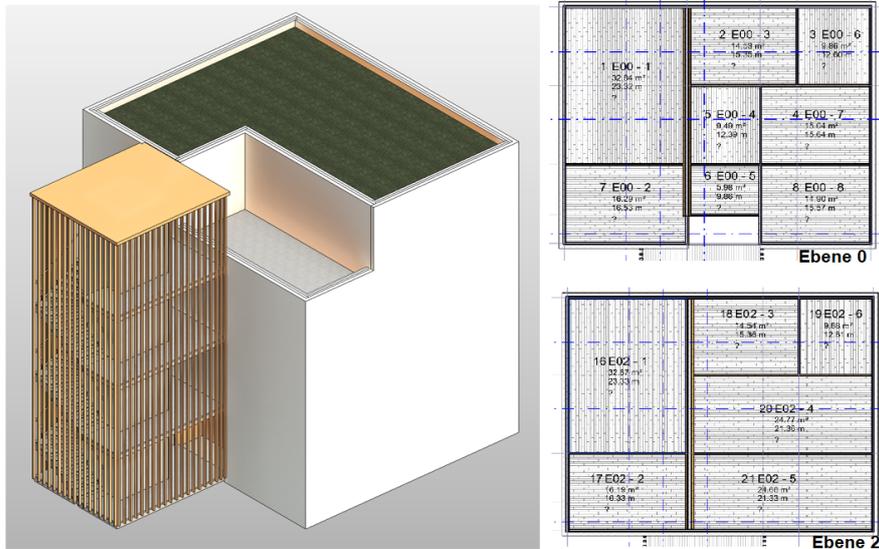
Darstellung eines Referenzgebäudes mit unterschiedlichen Grundrissen je Stockwerk, um eine Vielzahl an Stoßstellensituationen zu simulieren (nicht maßstabsgetreu)
